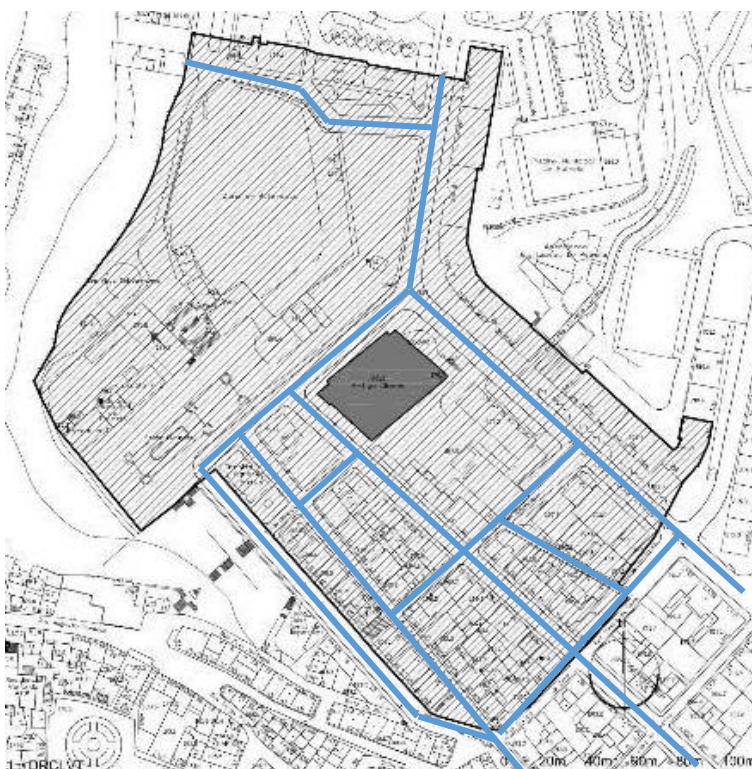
Planta de implantação do Cine-teatro S. João. Importância da malha do quarteirão e ruas que definem o largo perceptível na planta da vila.
